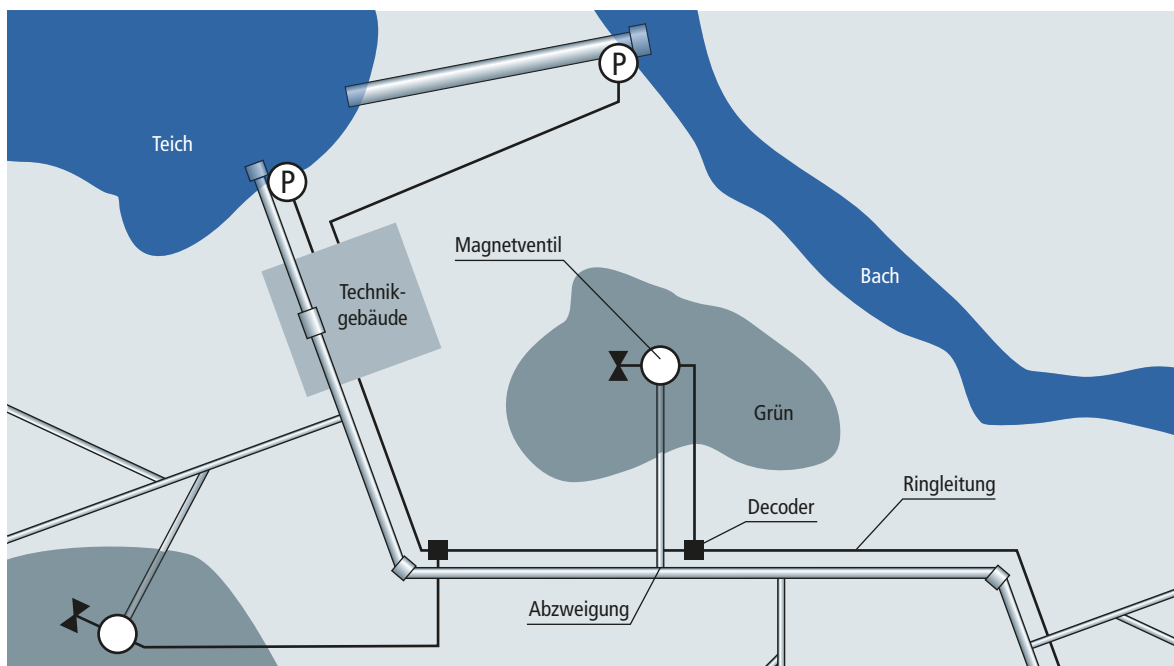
Druckleitung mit Abzweigen, Magnetventilen, 2-adriger Ringleitung und Decodern
